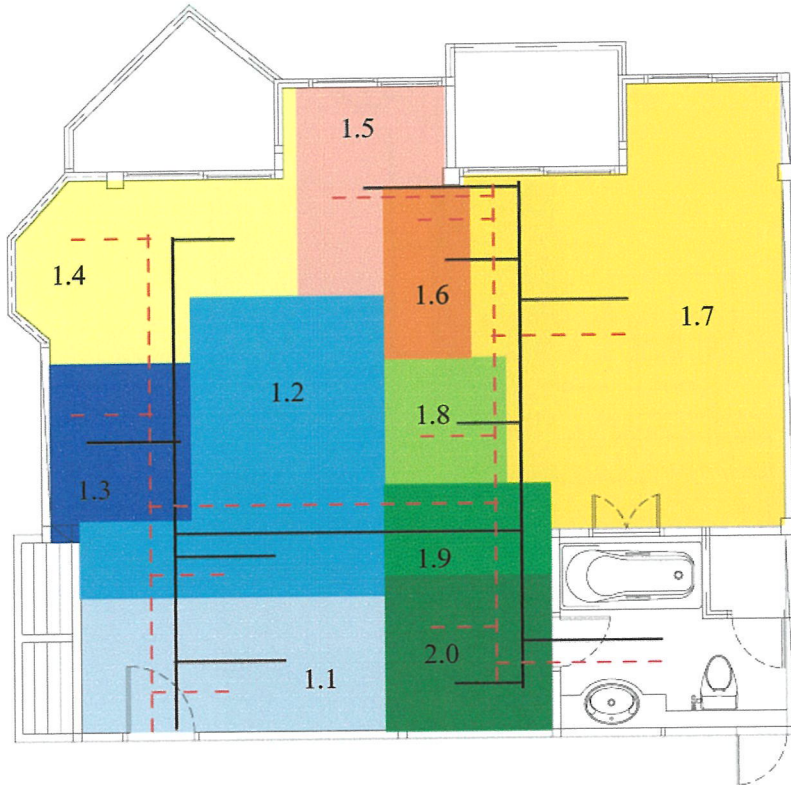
แสดง ZONING ส่วนห้องพักแบบ (STANDRAD ROOM)
